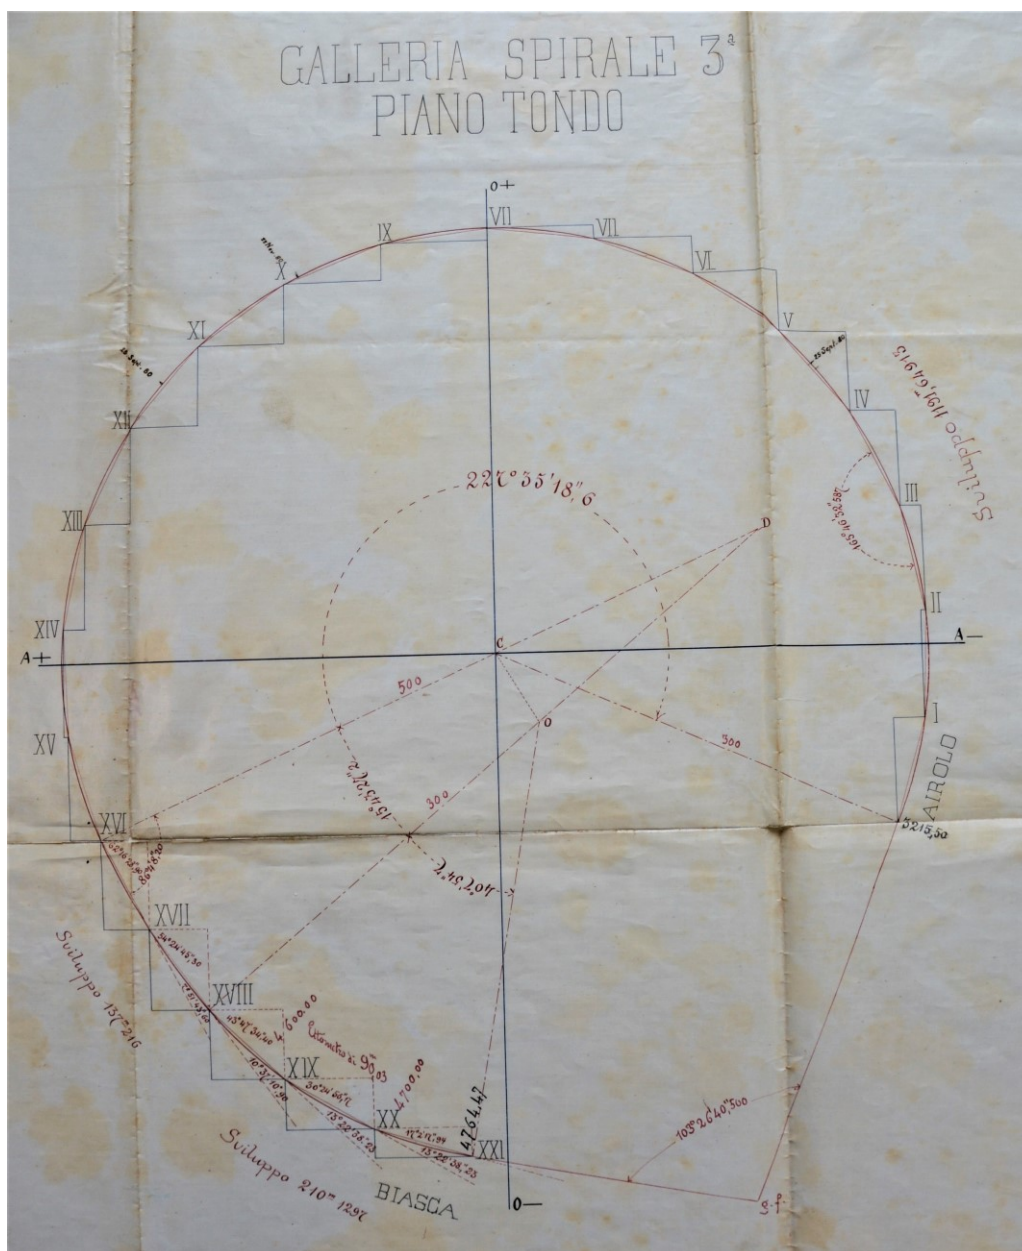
Absteckungsplan Kehrtunnel Pianotondo, 1878 (SBB Historic, PL_120_00014)
